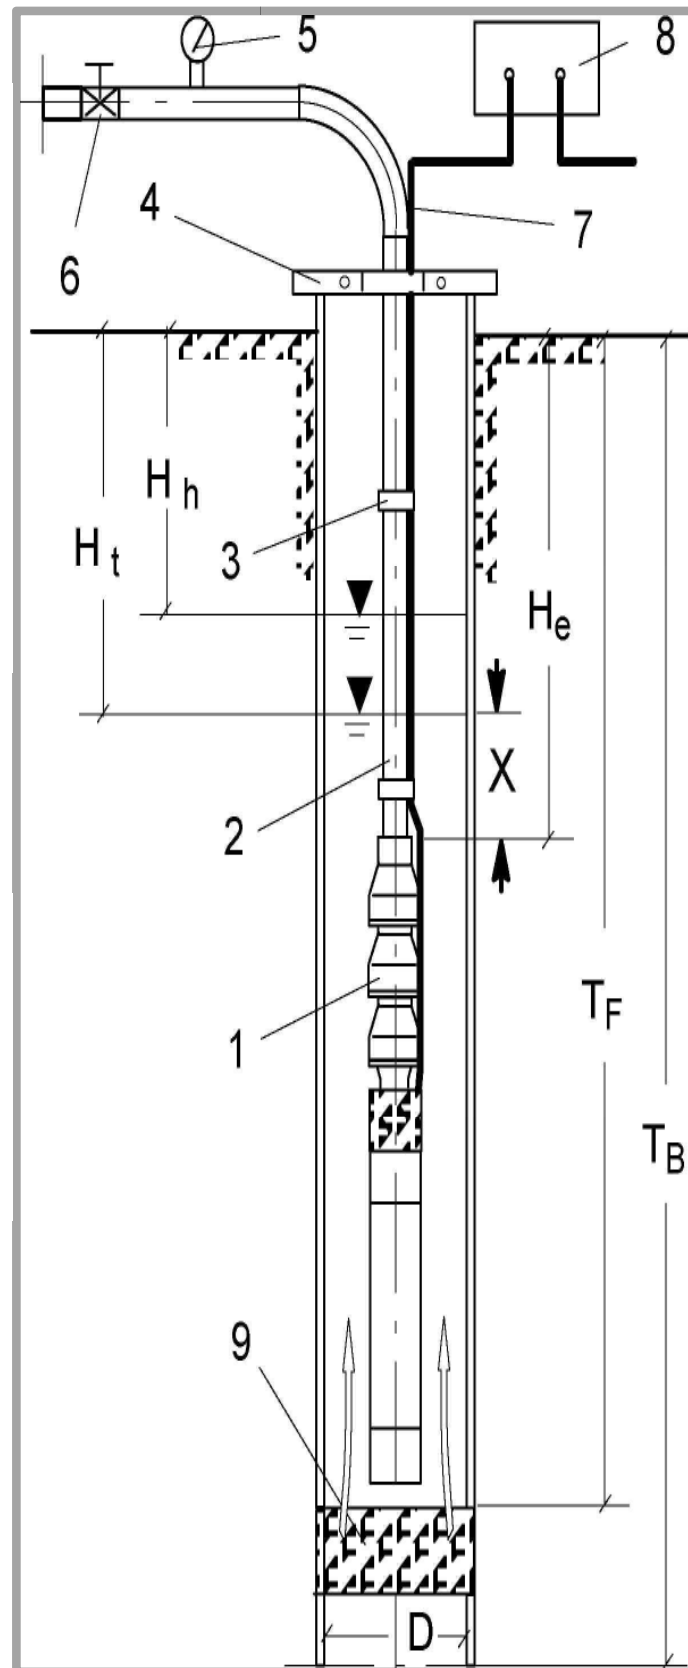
installation verticale d'un groupe électropompe dans un forage
